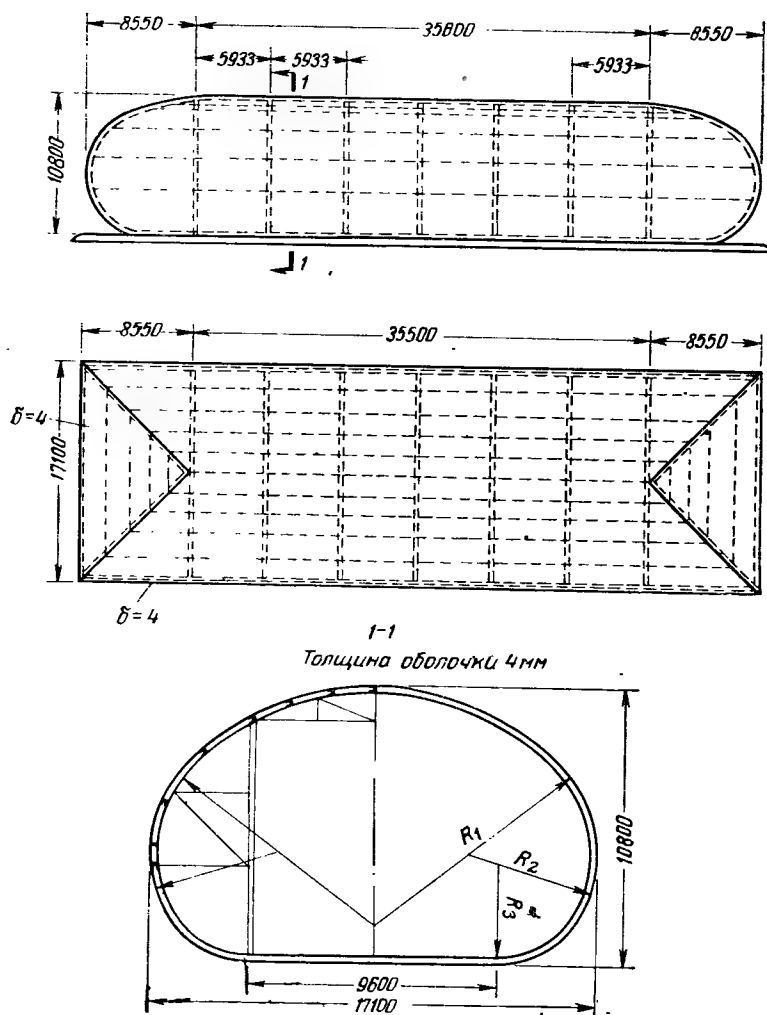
Каплевидный цилиндрический резервуар (цилиндронд) конструкции А. Г. Соколова
